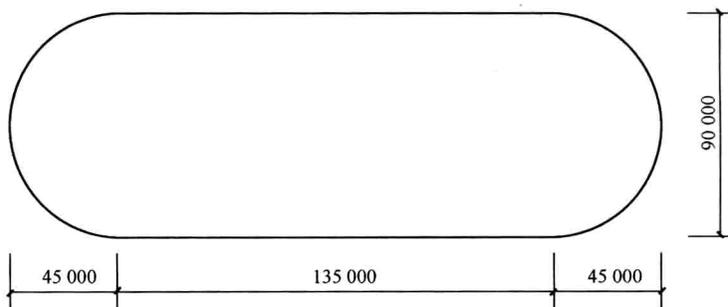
某建筑物底层平面示意图(单位:mm)
